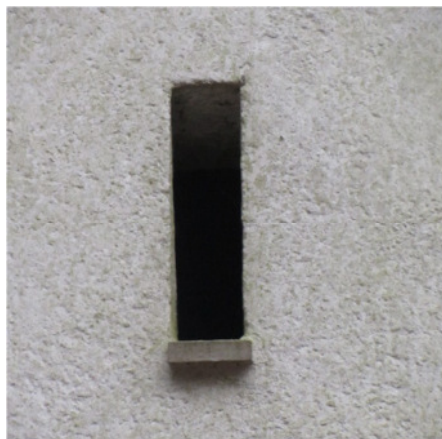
Öffnung (Lüftung?) an der Vorderseite des Garagengebäudes
